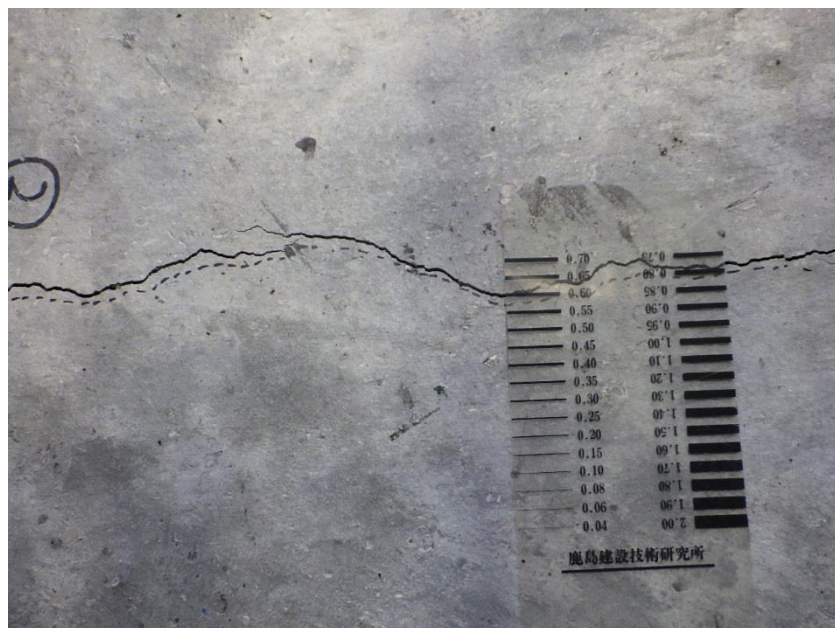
鉄筋コンクリート試験体ひび割れ発生状況 (①・②同時拡張後 3/3)
